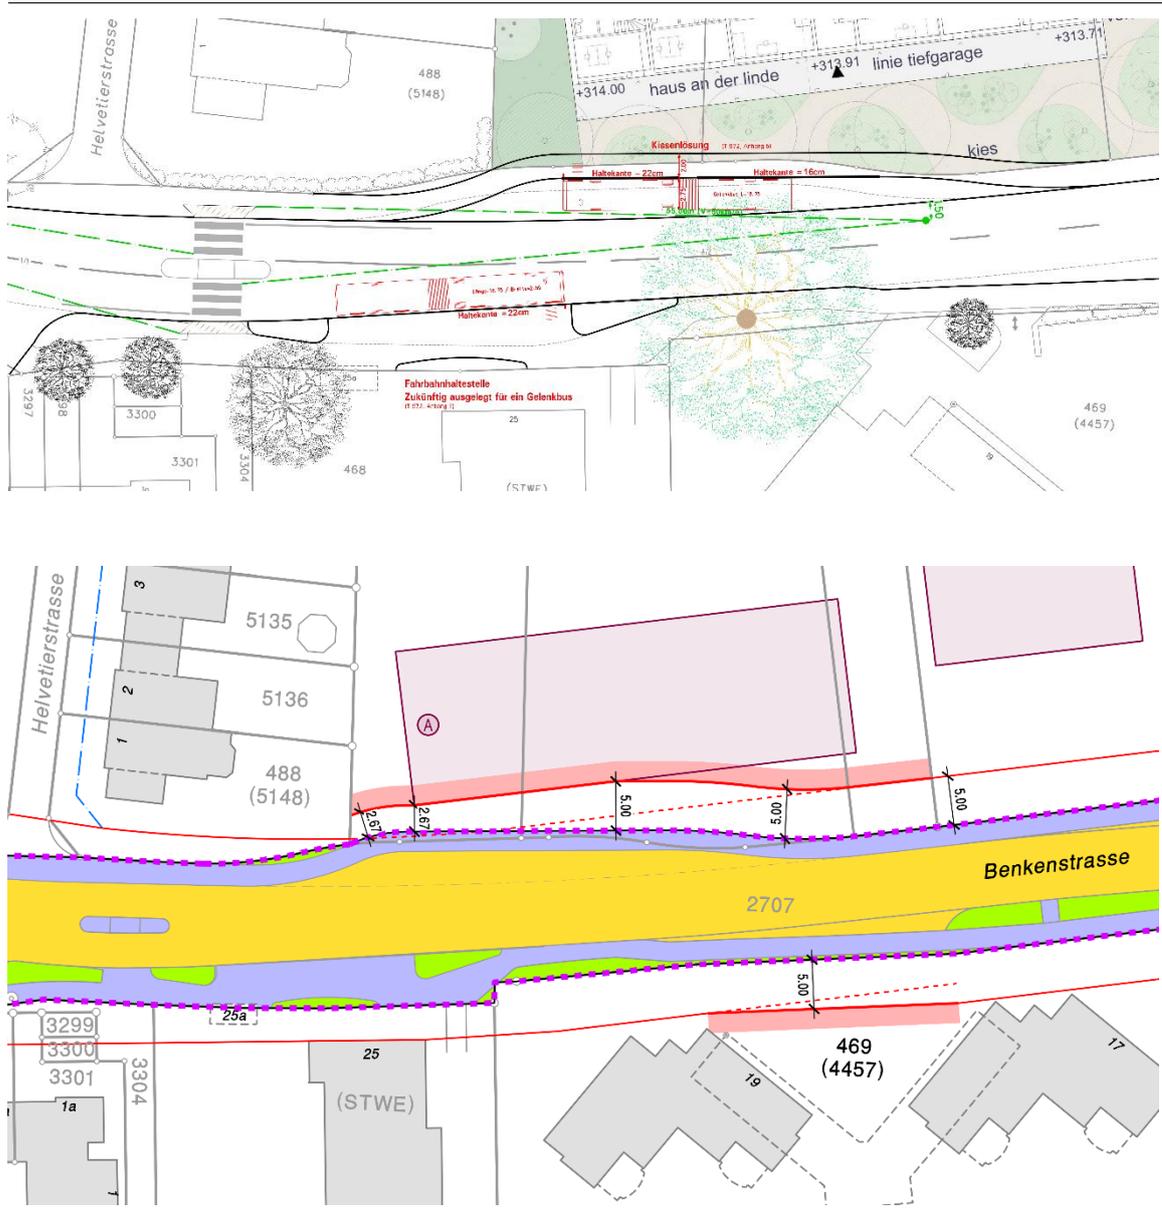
Oben: Ausschnitt Bauprojekt Benkenstrasse, 13.03.2023
